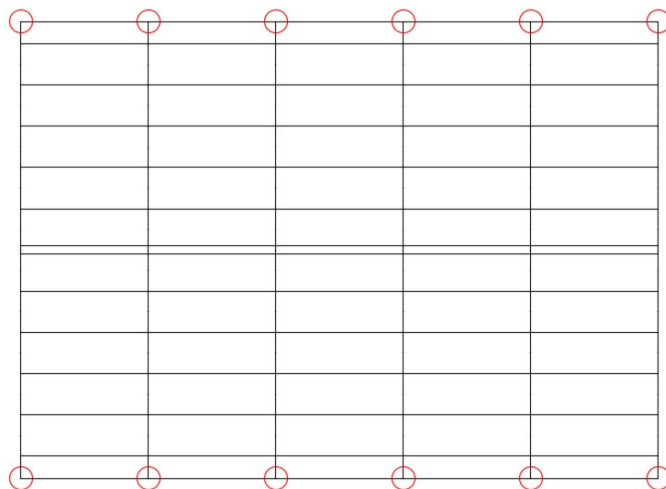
Vista en planta de la cubierta señalando las columnas donde se colocarán placas base
